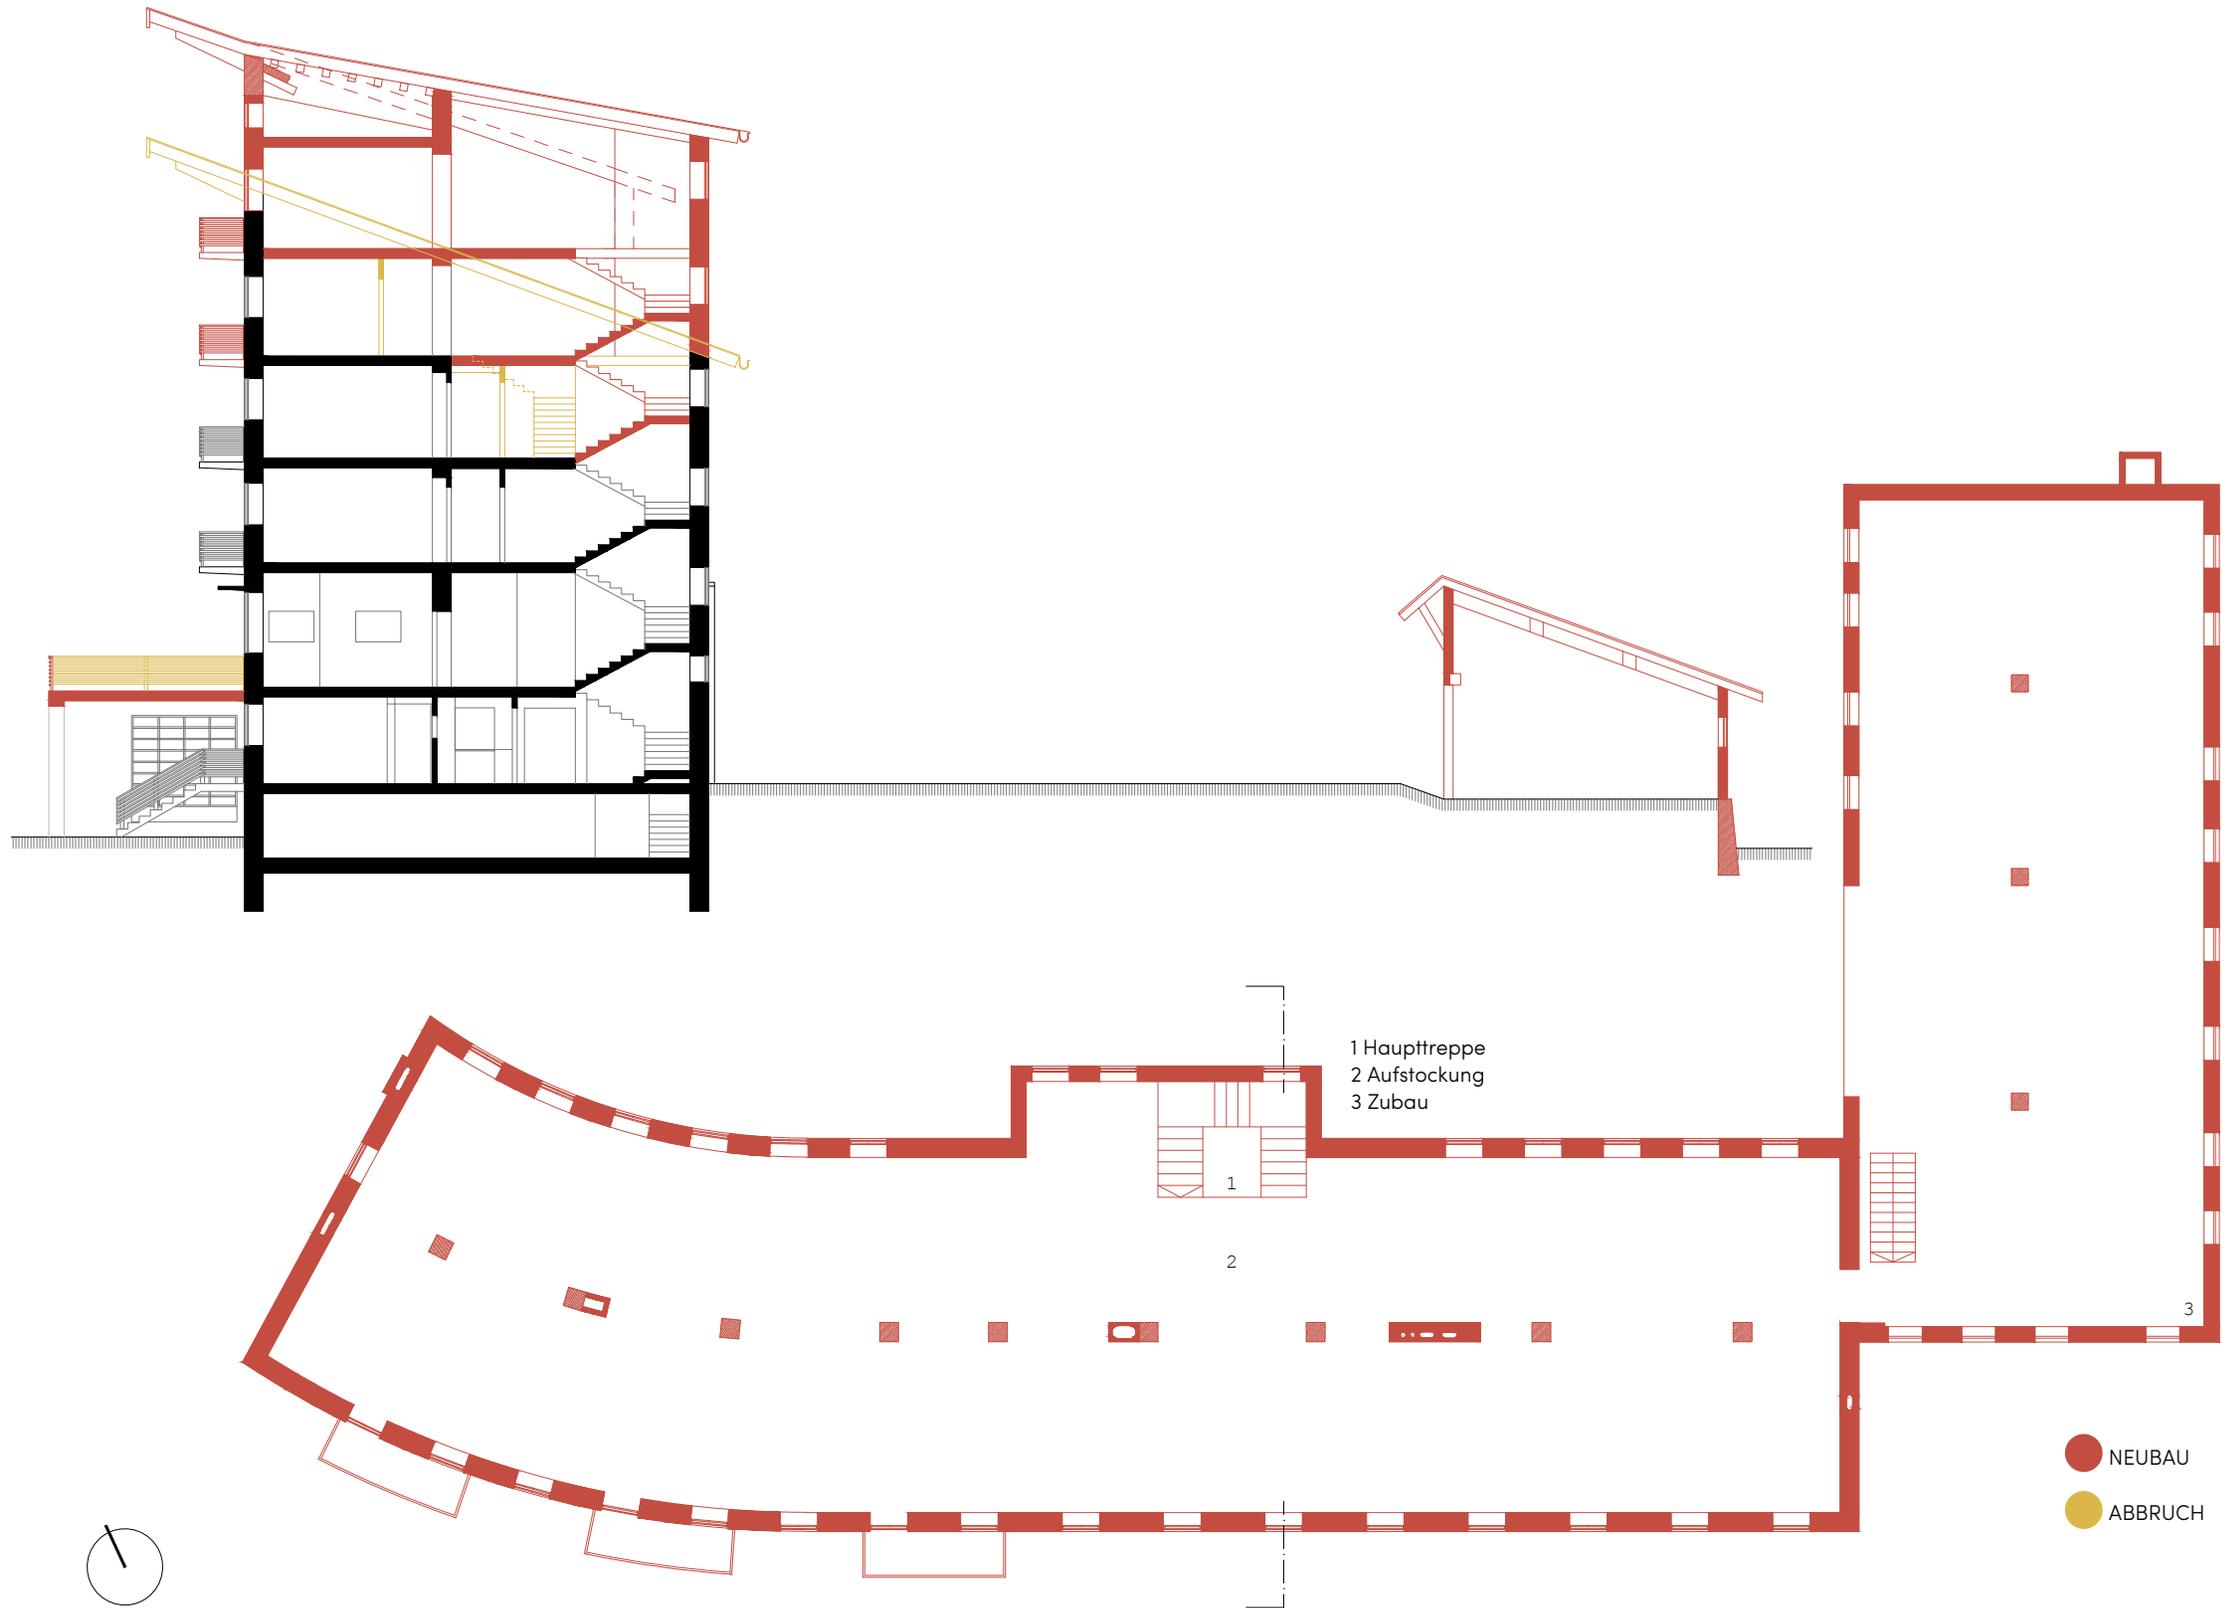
Grundriss Dachgeschoss & Schnitt 1:200
